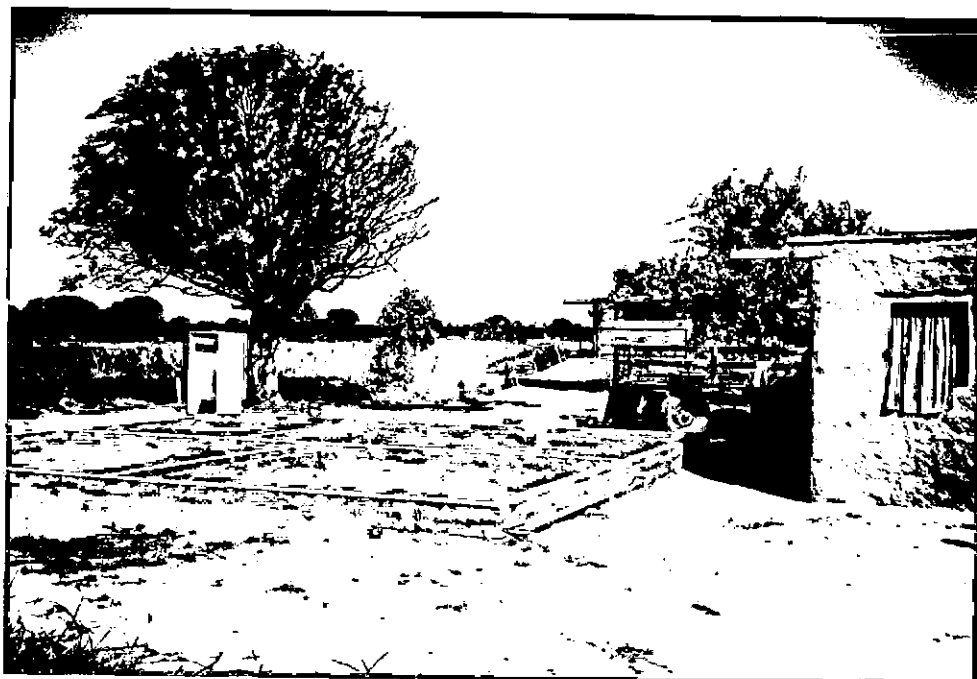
Paraje Boquerón, tierras de la familia Alfonso. Vivienda en construcción,
